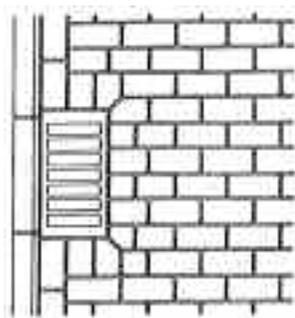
Formación de un canal de entrada con ayuda de elementos prefabricados para canalizaciones de hormigón y cubierto de tapa de fundición. Colocación del pavimento en lecho de arena sobre capa portante de hormigón. Además de las pendientes necesarias de 2,5 cm/m se ha de prever evacuación del agua, como en el ejemplo de los canales, entradas de agua o drenajes. Este tipo de medida depende del estado o modalidad de las capas portantes, y del subsuelo así como de la forma de colocación.
